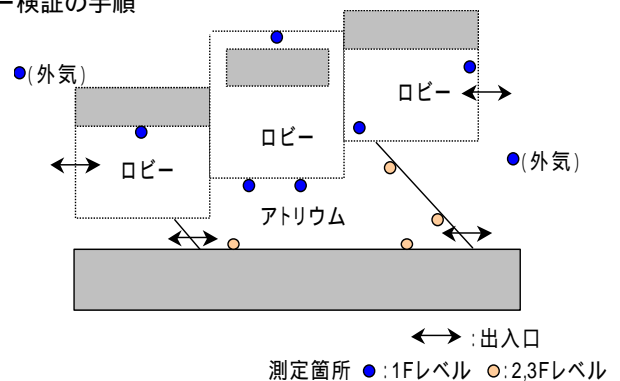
アトリウムロビー概略平面図と室内温度測定箇所
